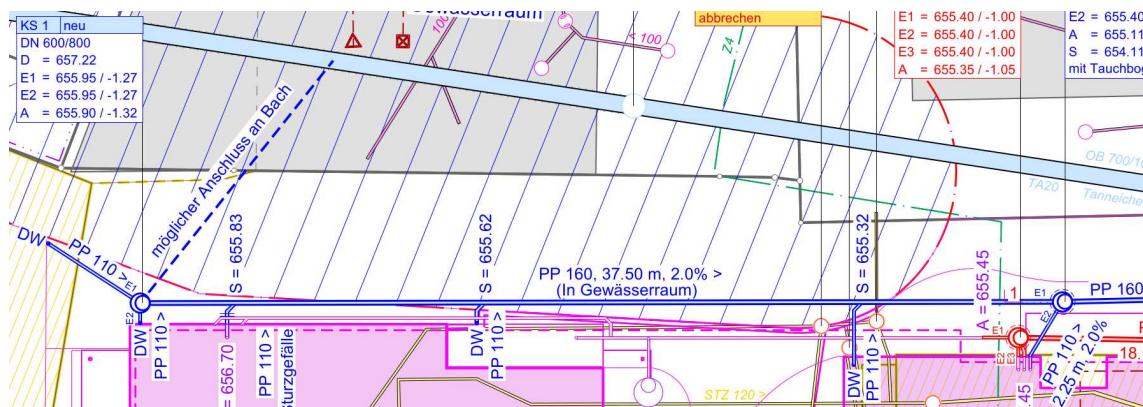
Ausschnitt Regenwasserleitung im Gewässerraum
